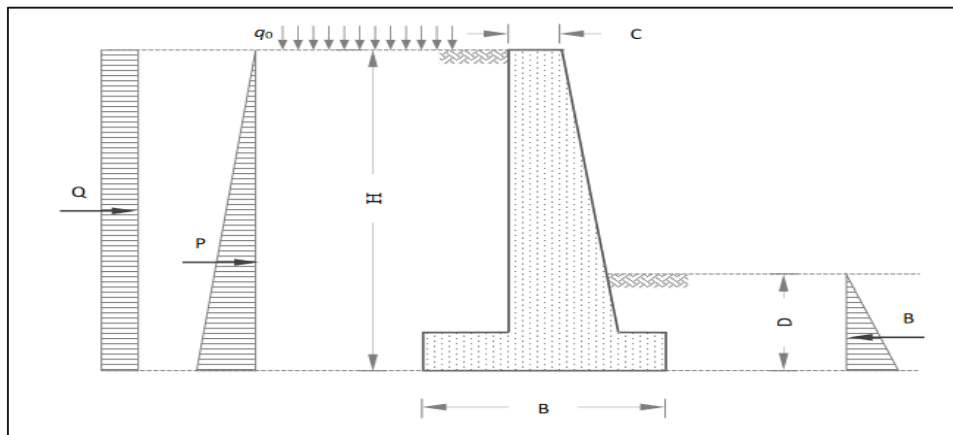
Coupe transversale schématique du mur de soutènement en béton armé diagramme des efforts.
